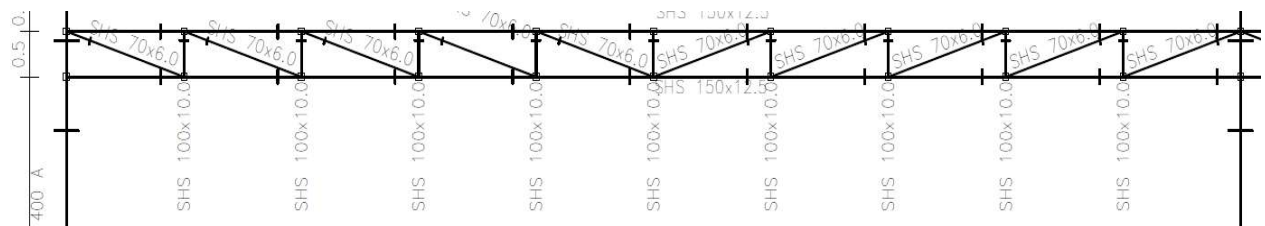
Detalle constructivo de la viga Pratt Superior. Fuente propia
